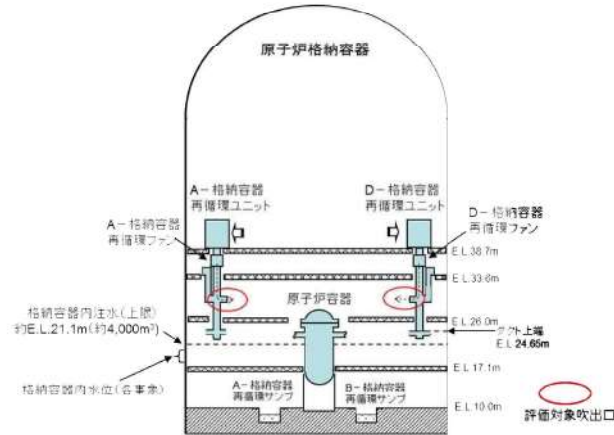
格納容器再循環ユニット配置概要図（原子炉格納容器断面図）
